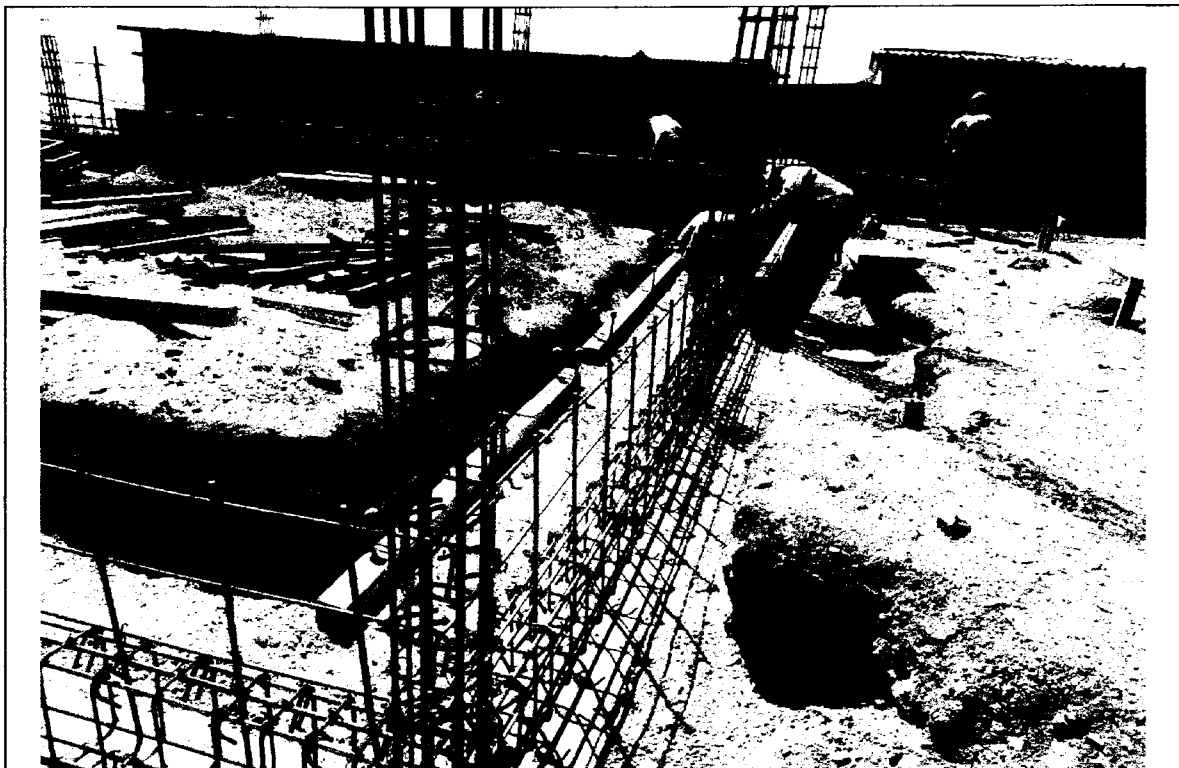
ARMADO DE LA ESTRUCTURA DE ACERO DE REFUERZO EN VIGAS DE CIMENTACION Y SOBRECIMIENTOS DEL MODULO II.
